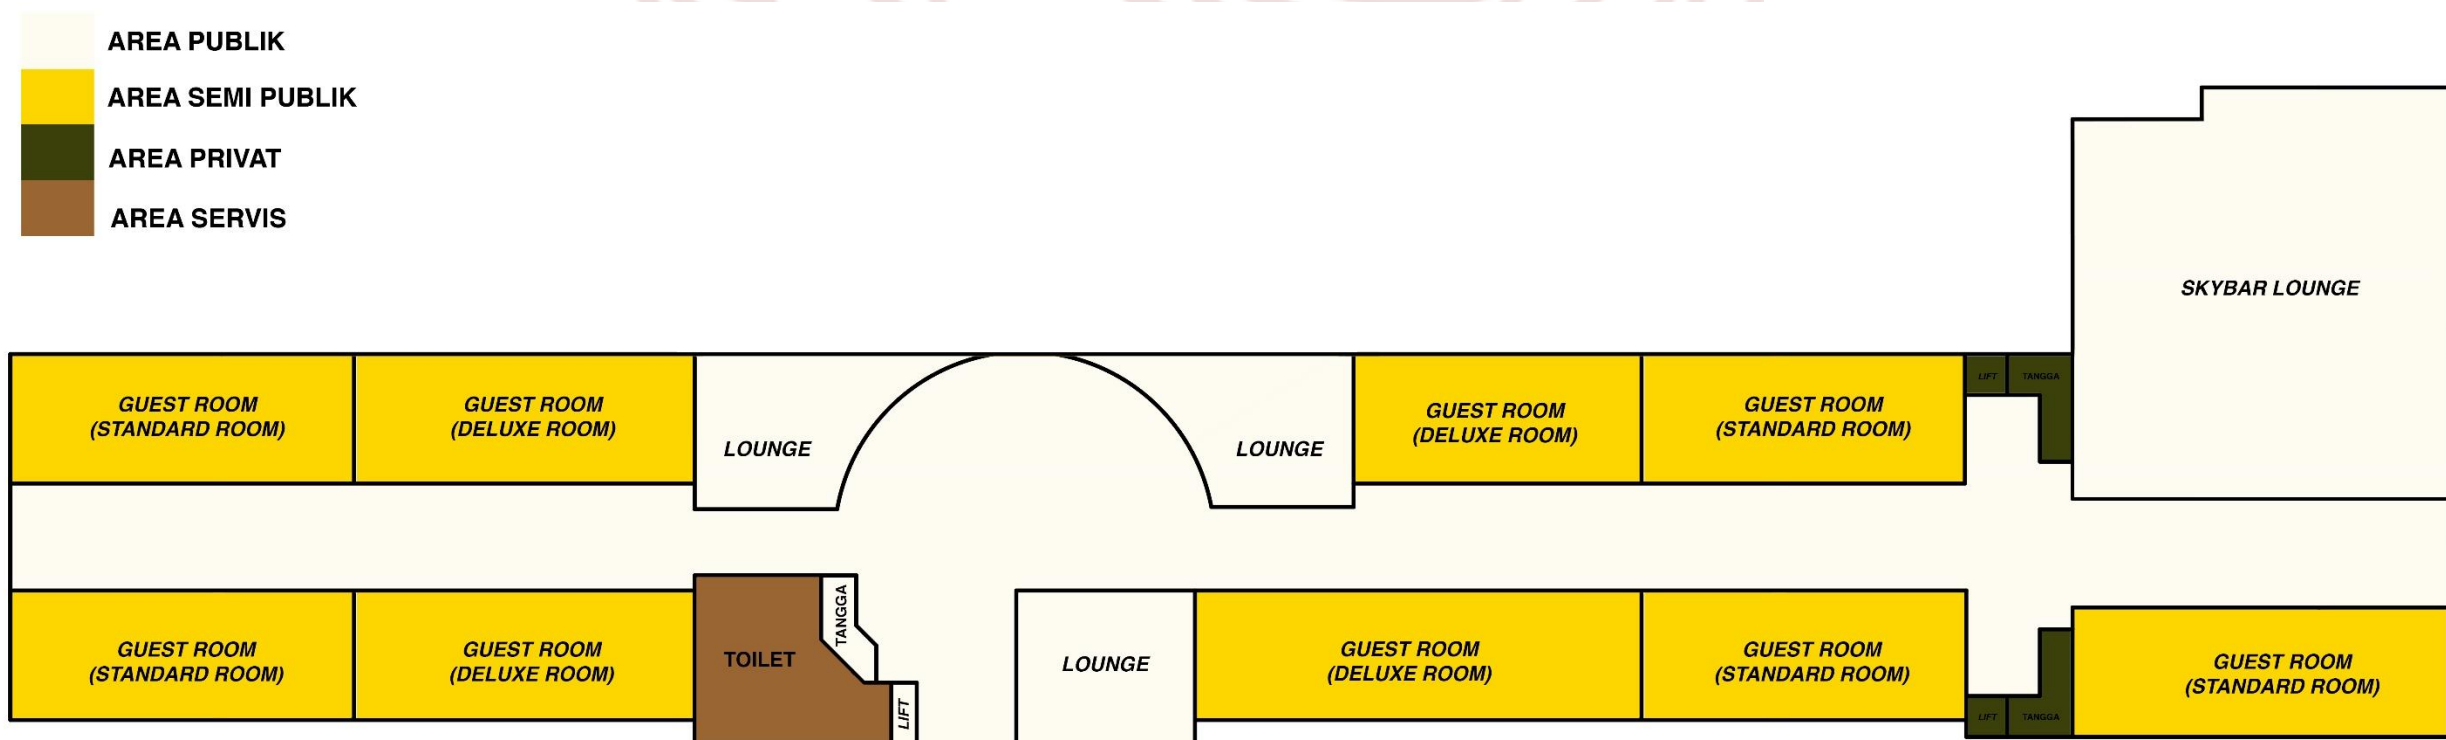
Alternatif 1 Grouping Zoning Lantai 2
